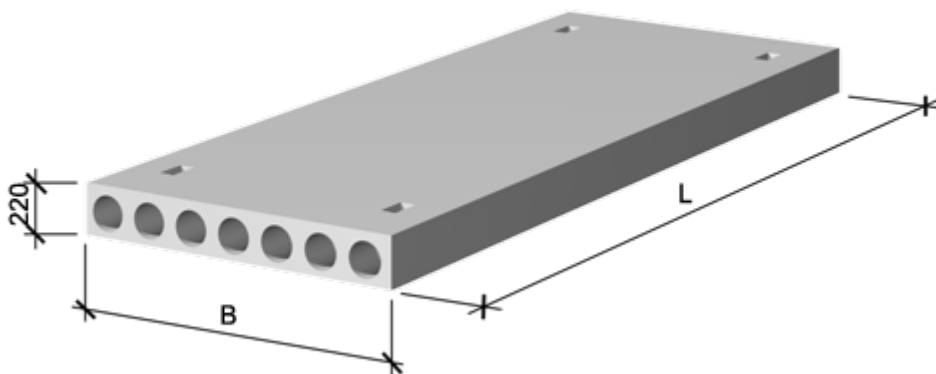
Пустотна плита перекриття товщиною 220 мм
